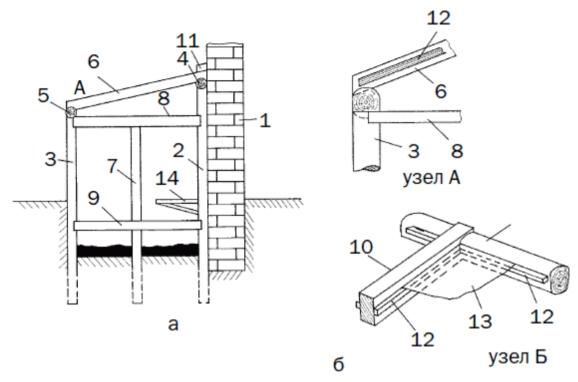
Котлованная односкатная теплица: а – внешний вид; б – узлы каркаса; 1 – южная стена жилого дома; 2, 3 – столбы; 4 – верхний лежень; 5 – нижний лежень; 6 – стропила; 7 – столб для второго косяка двери; 8 – поперечные рейки верхней обвязки; 9 – поперечные рейки нижней обвязки; 10 – дополнительные рейки (шпросы); 11 – рейка-нащельник; 12 – рейки для укладки стекол; 13 – стекло; 14 – стеллажи
